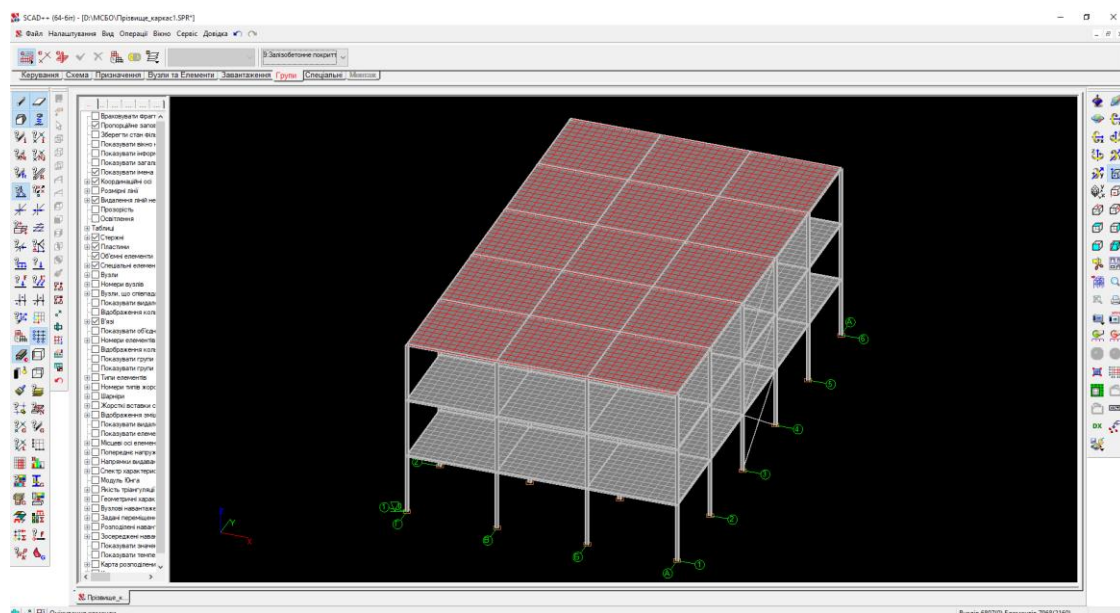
Активована група «Залізобетонне покриття» на розрахунковій схемі
